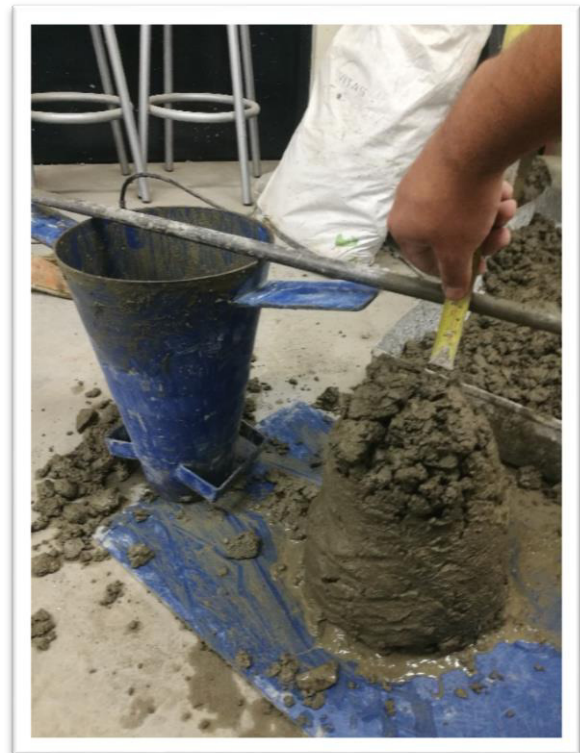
Elaboración del concreto para vaciar en las probetas y viguetas.
